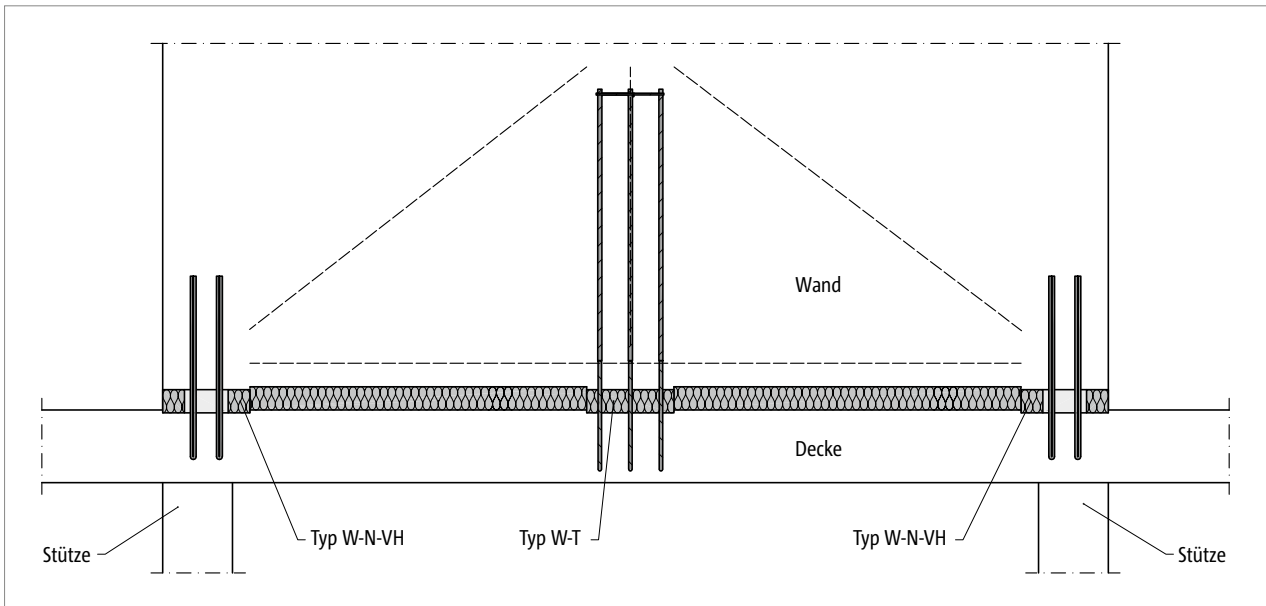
Schöck Scconnex® Typ W: Kombinierte Produktvarianten für den Anschluss eines wandartigen Trägers mit Deckenaufhängung
